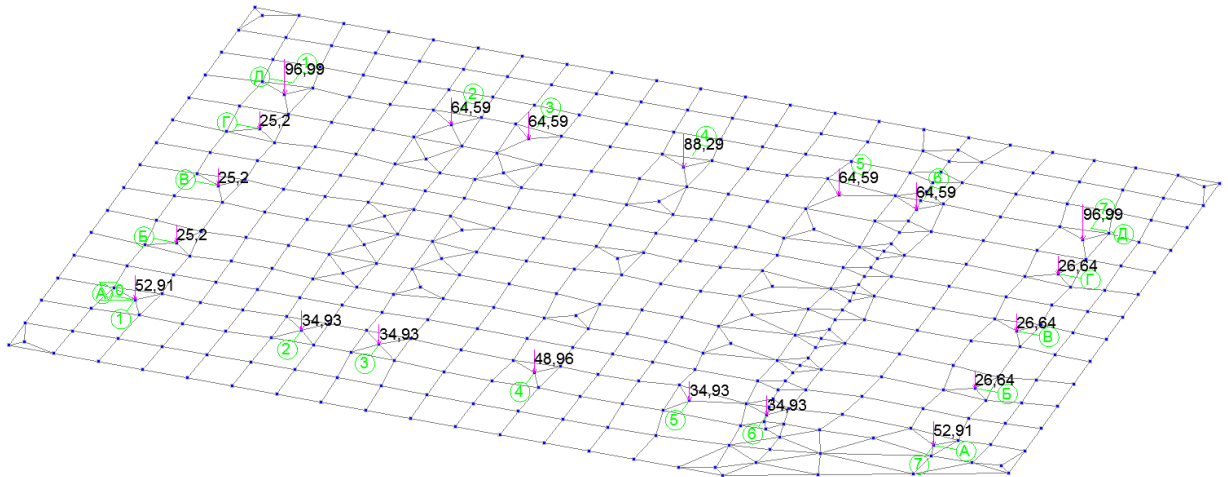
Постоянная нагрузка на фундаментную плиту от грунта и перекрытие подвала
